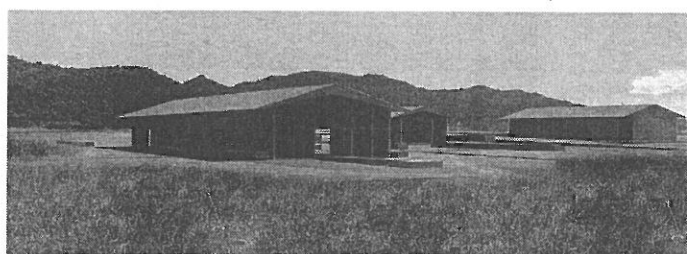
Plan d'ensemble des installations projetées (dossier SIRACO)
